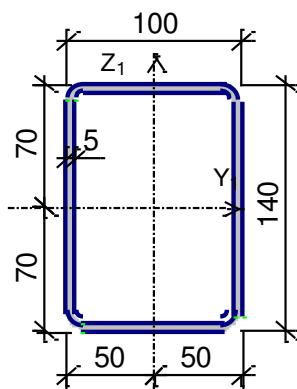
Сечение прямоугольной трубы 140x100x5 мм
